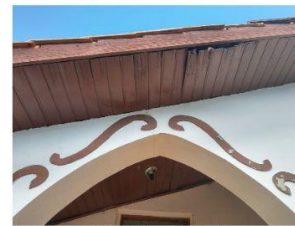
Vista detalhe do ornamento: Arco varanda.
